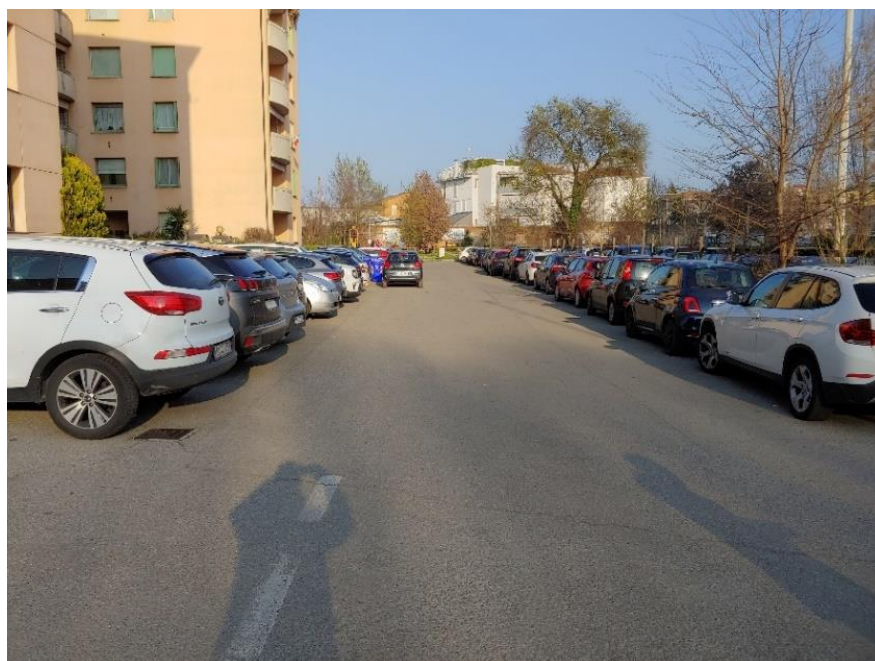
Vista ingresso area di parcheggio esistente (area Nord)
